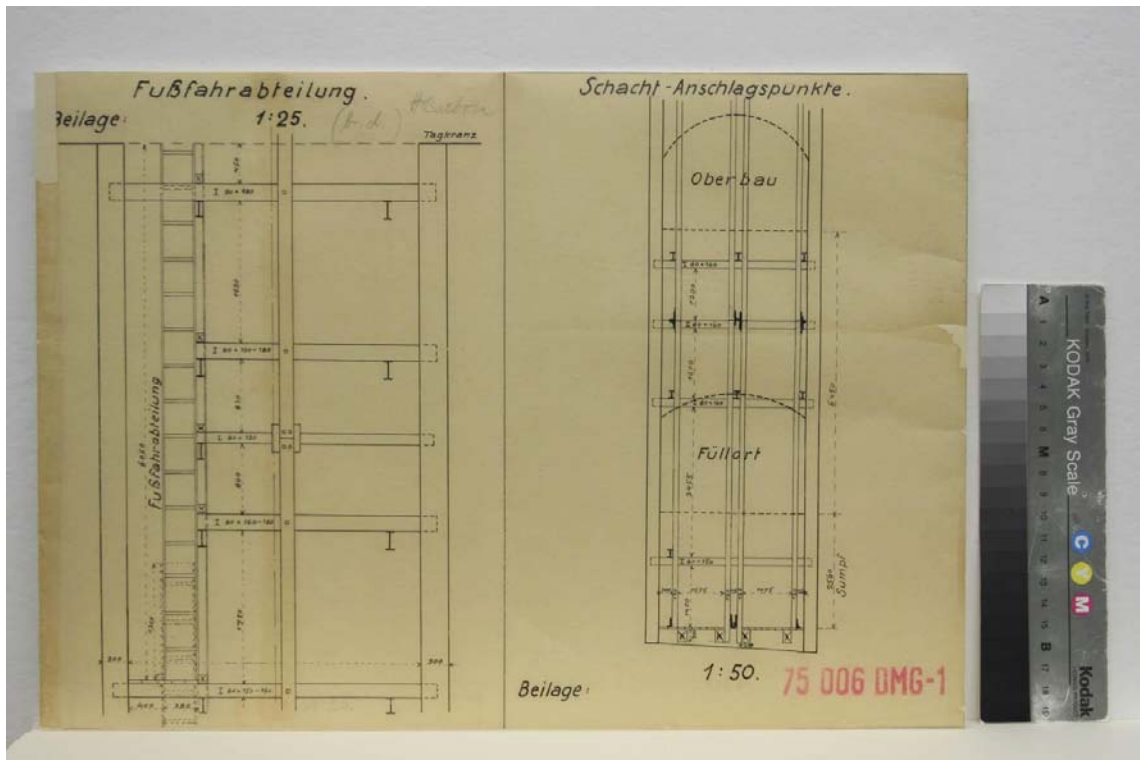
Stav po restaurování, detail na pravém okraji po podlepení a doplnění chybějící části.
